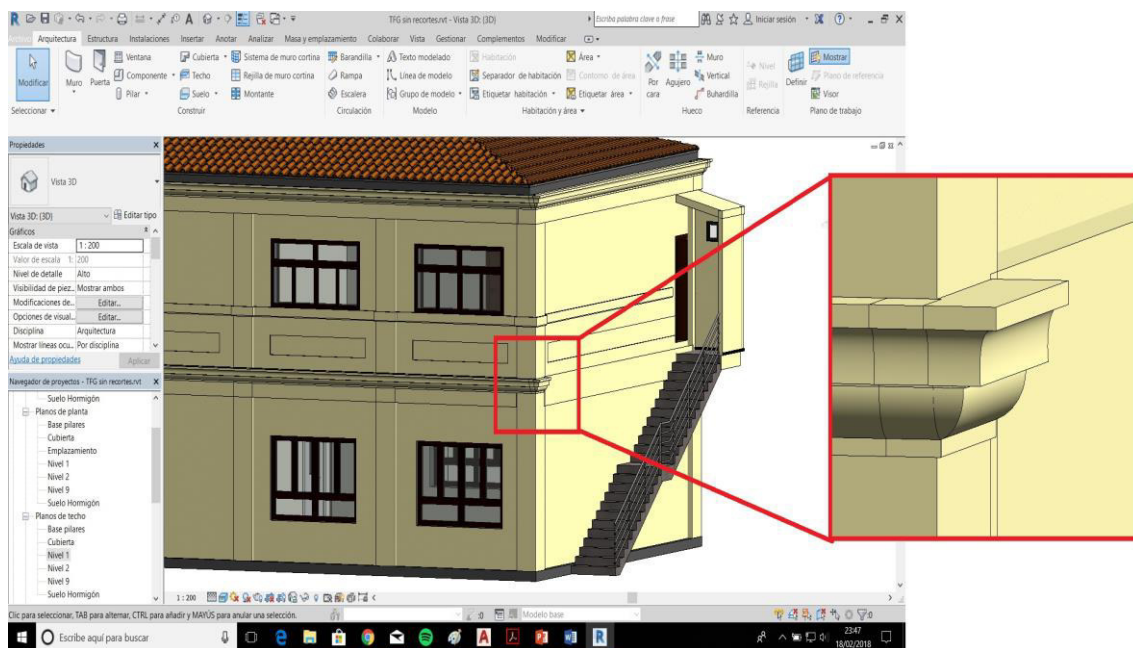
Detalle del perfil de la cornisa de la fachada
